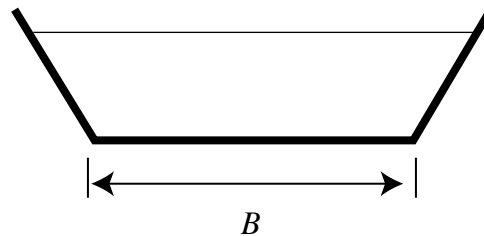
Canale di sezione trapezoidale con sponde inclinate di 45° gradi.
